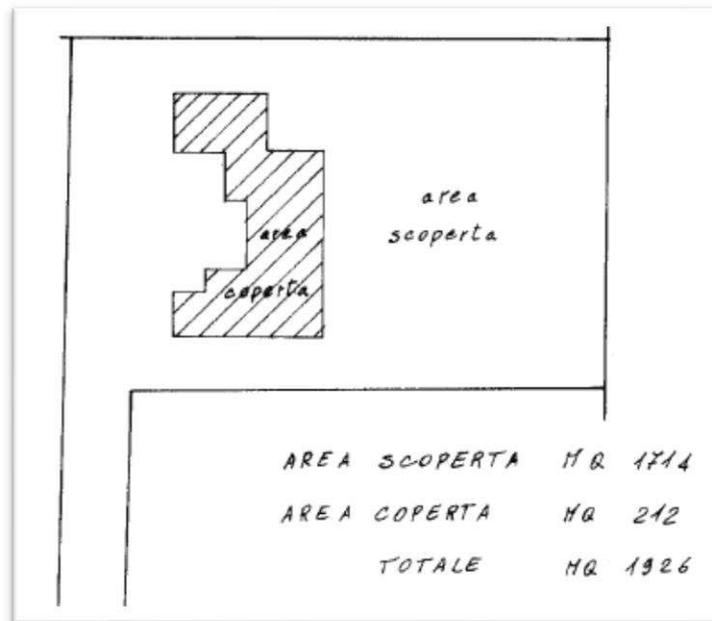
a: Estratto Planimetria catastale Mappale 315, Sub. 3
